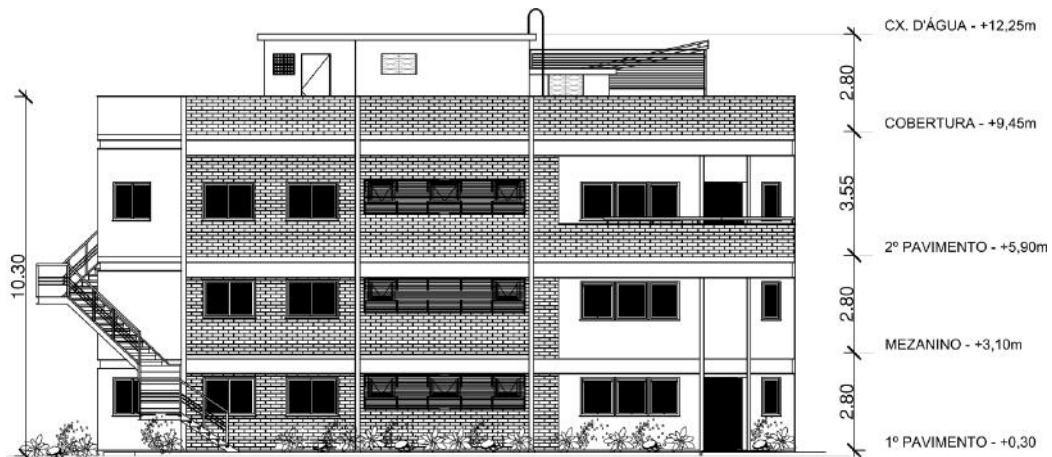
Geometria do Laboratório Bioetanol – Elevação – Dimensões em metro
